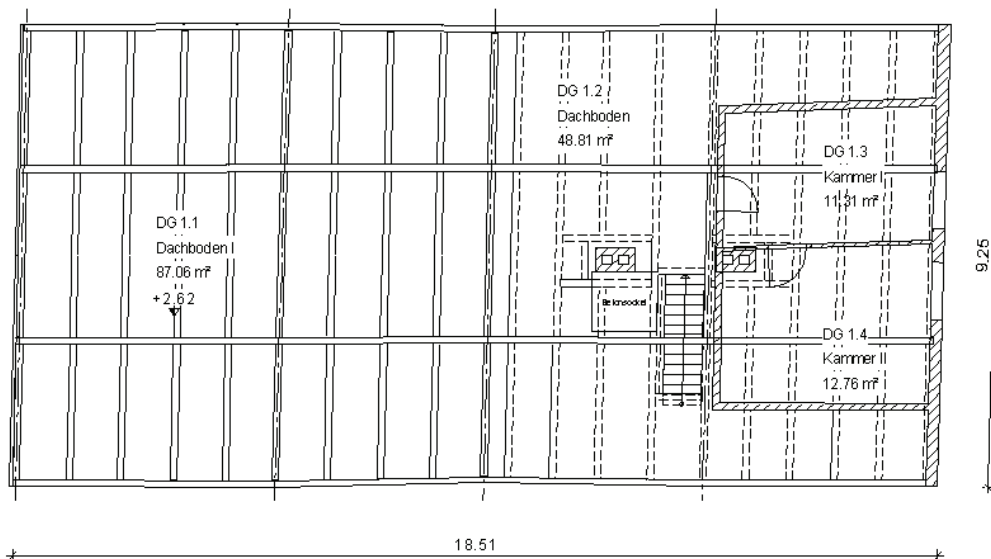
Dachgeschoss, schematischer Grundriss
